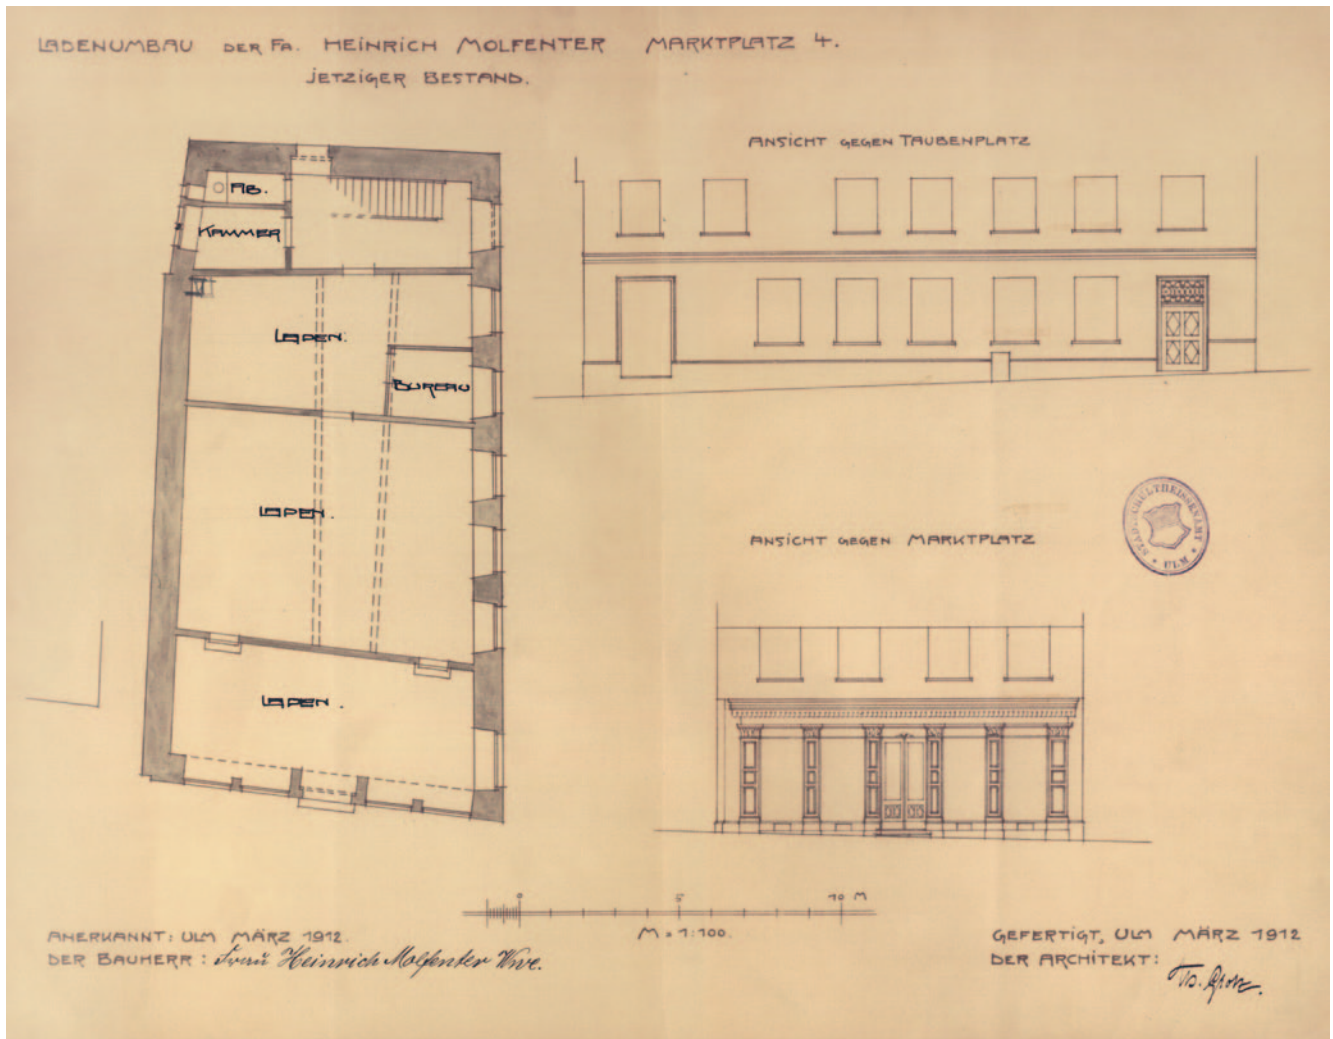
Gebäude Marktplatz 4 (A 339), Bekleidungshaus Molfenter, Erdgeschossgrundriss und Teilansichten, Zustand vor dem Umbau, Baugesuch 1912.
